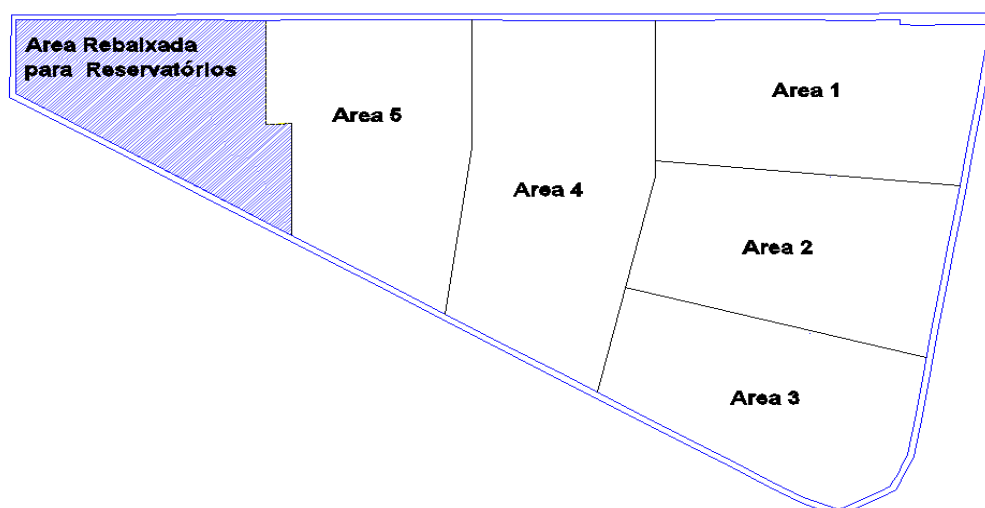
Divisão de áreas para betonagem do ensoleiramento geral
